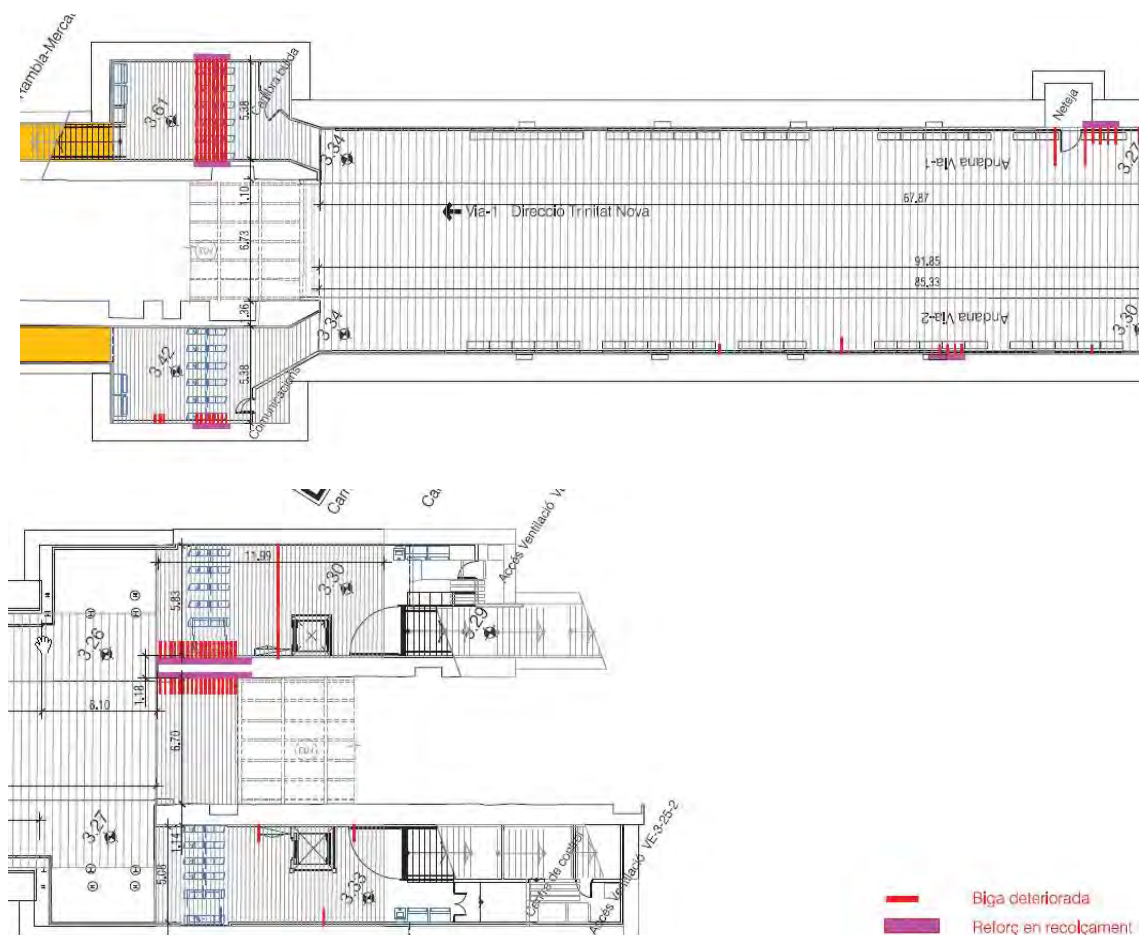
Plantas de zonas a reforzar según proyecto de reparación
